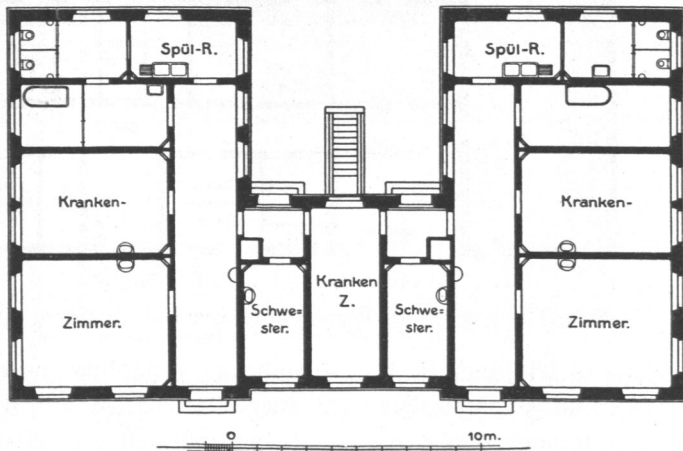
Allgemeines Krankenhaus Hamburg-St. Georg, eingeschossiger Pavillon für Beobachtungen, GrundriÙ.
